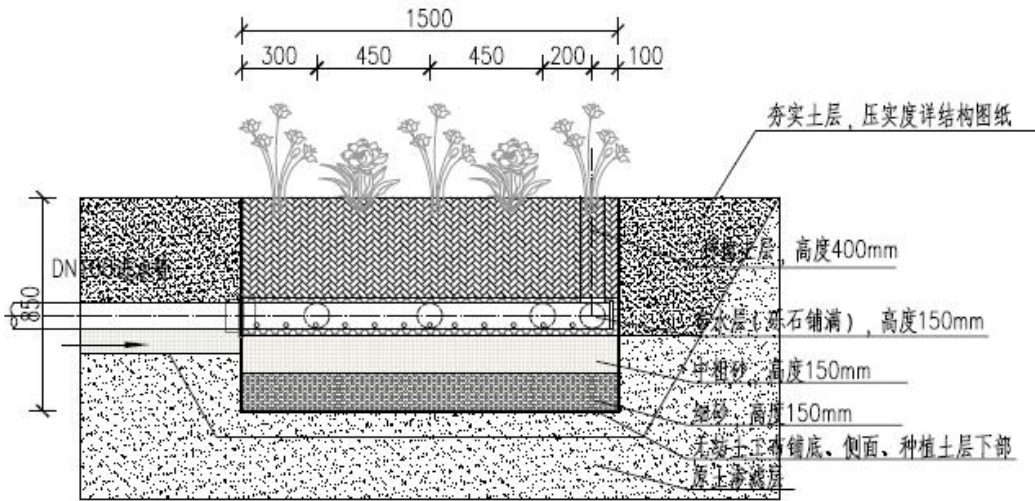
多介质土壤生态滤池 B-B 剖面示意图
